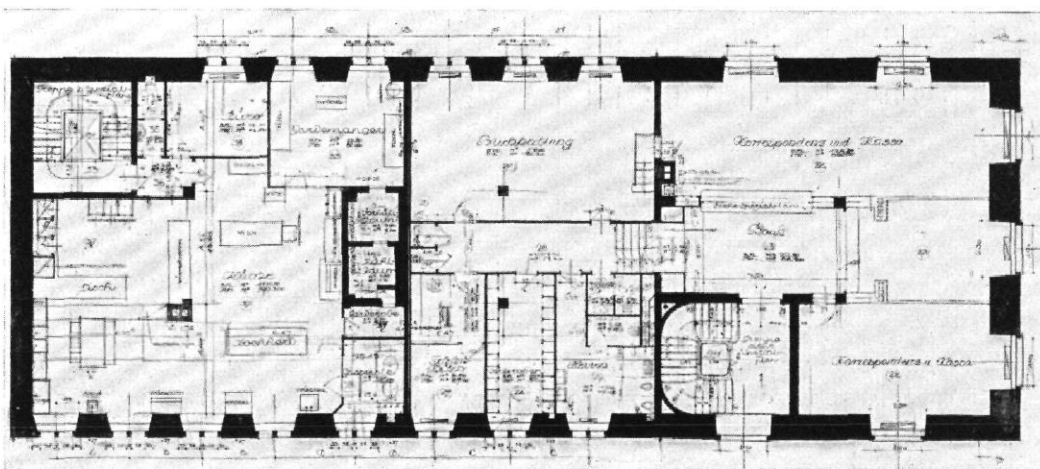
und 93 | Zürich | Umbau des alten Zeughauses am Paradeplatz | Architekten: Schärer und Risch, Zürich | Das alte Zeughaus nach dem Umbau und Grundriß zum ersten Obergeschoß
